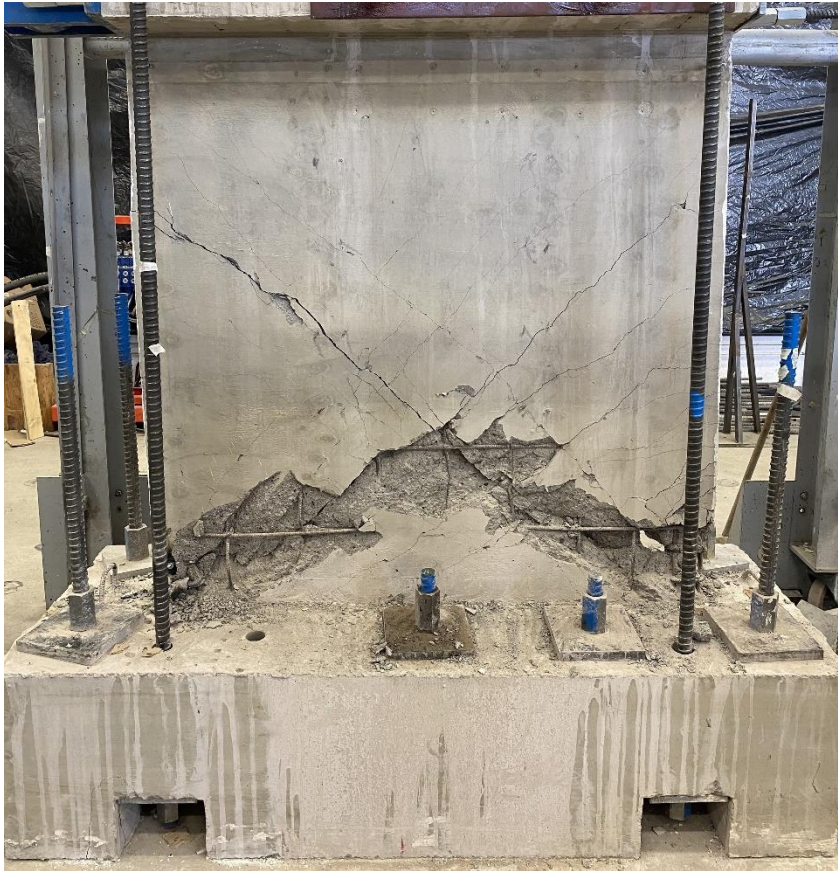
Vista final desde el lado sur del muro convencional.
